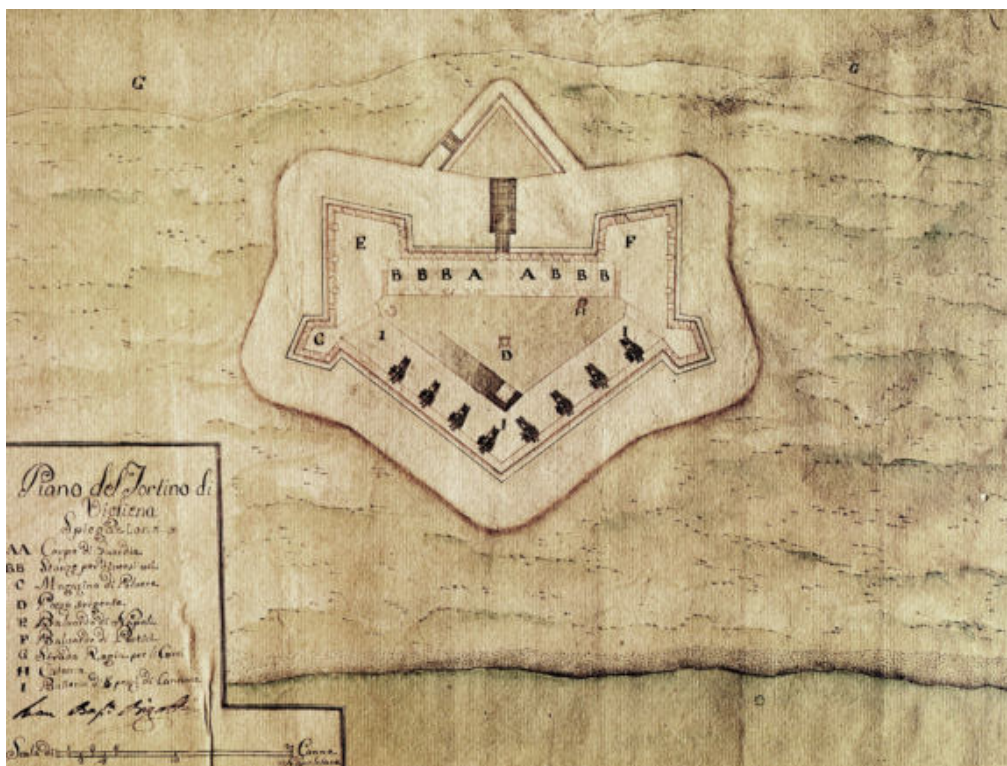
Pianta del Forte di Vigliena, Juan Baptista Bigotti (Archivio di Stato Napoli, Sala piante, b. 22, n. 3)
